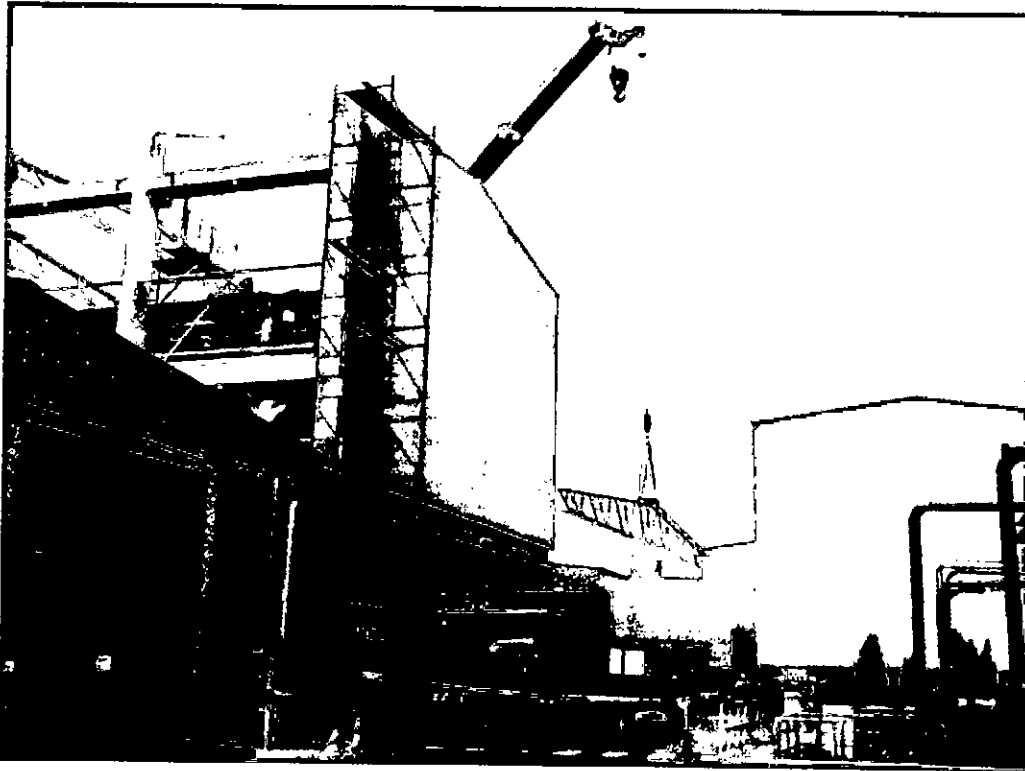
Desmontaje entre ejes 17 y 26 de la estructura metálica del techo, detrás de la grúa se aprecia que se van acumulando los rollos de papel, que luego de retirada la grúa, será trasladado a otro ambiente por los montacargas de Kimberly Clark
